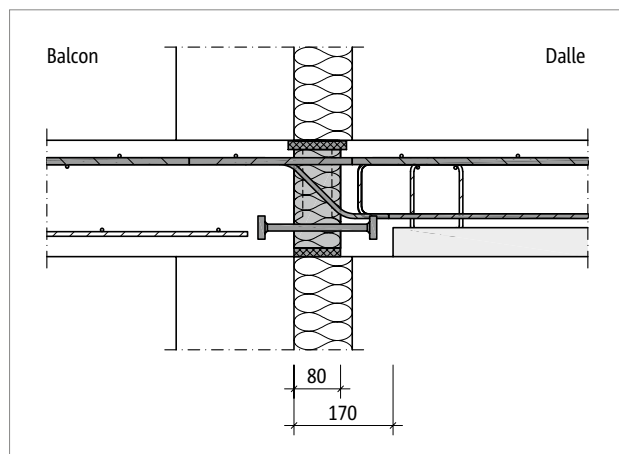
Schöck Rutherma® T type DB : distance minimale par rapport à la façade
